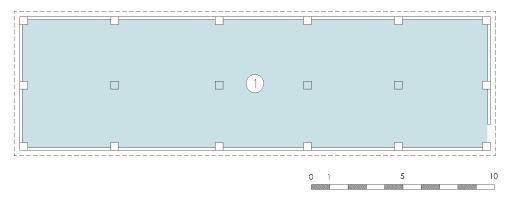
Planta primer nivel Bloque No.47. Fuente: equipo diagnóstico.
